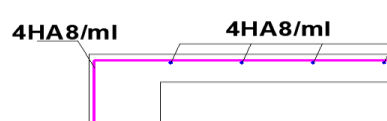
Ferrailage en travée de la DP4 sens X
